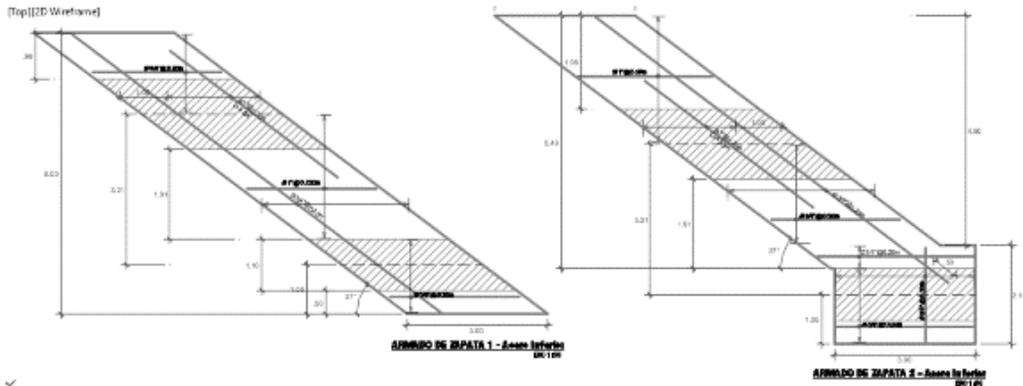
Detalle del acero dispuesto en las zapatas de la estructura de cuelgue.
